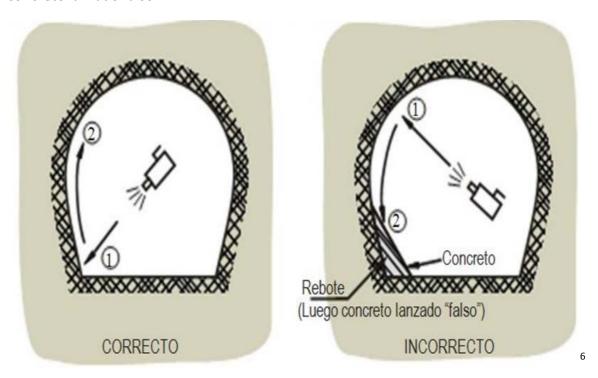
Se muestra el inicio y final del área de lanzamiento para evitar alto rebote y concreto lanzado falso
